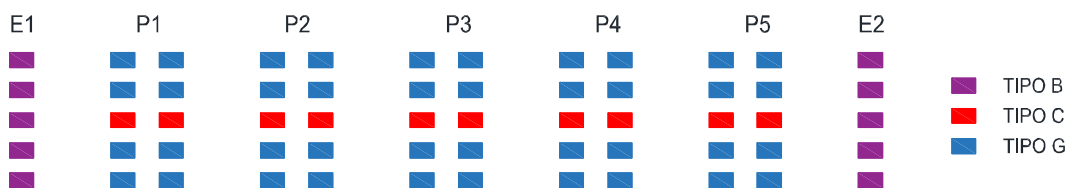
Distribución en planta de los aisladores LRB del Viaducto 1
